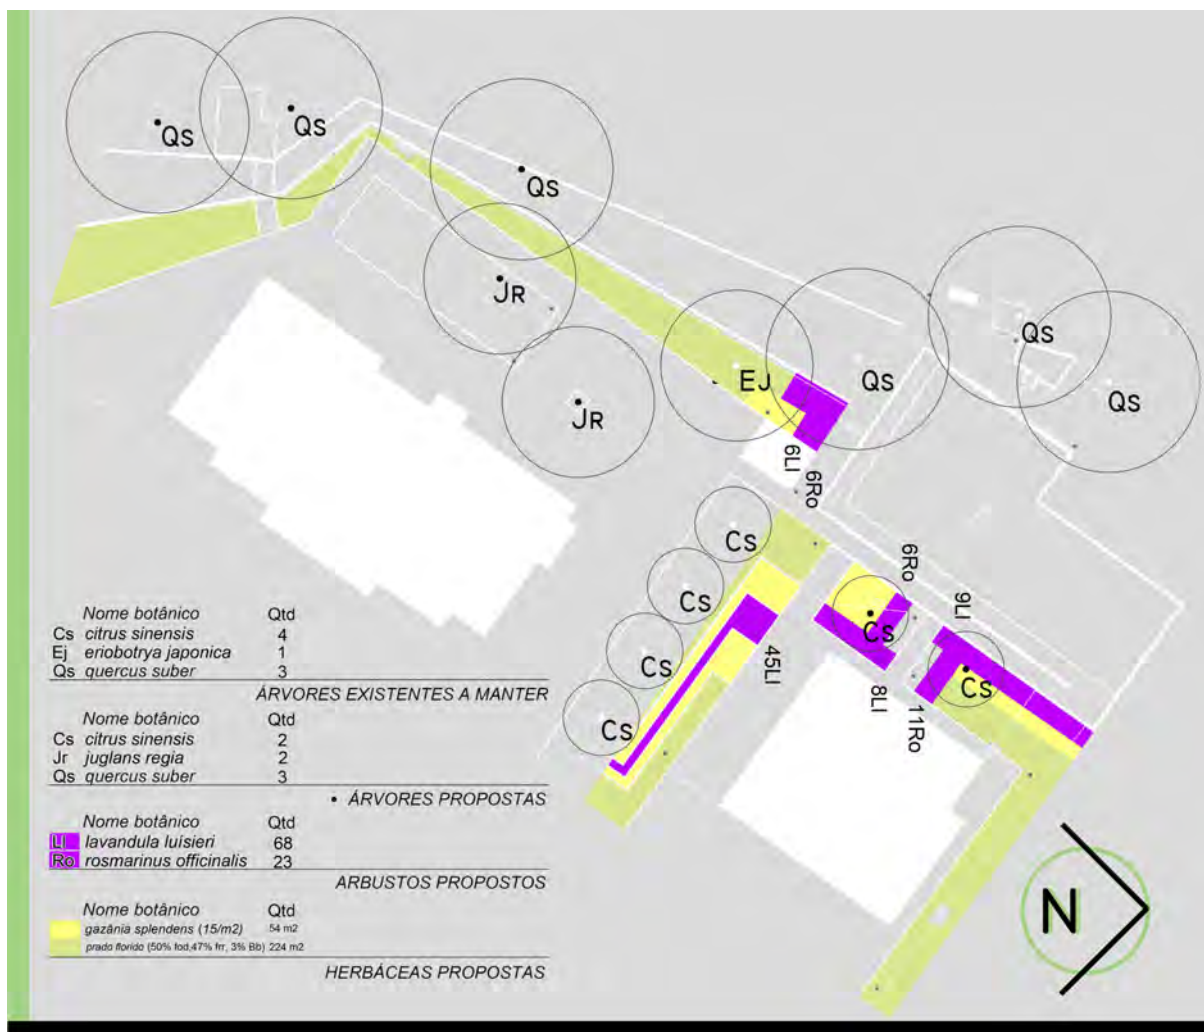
Plano de plantação. S/ escala. Fonte Autor
